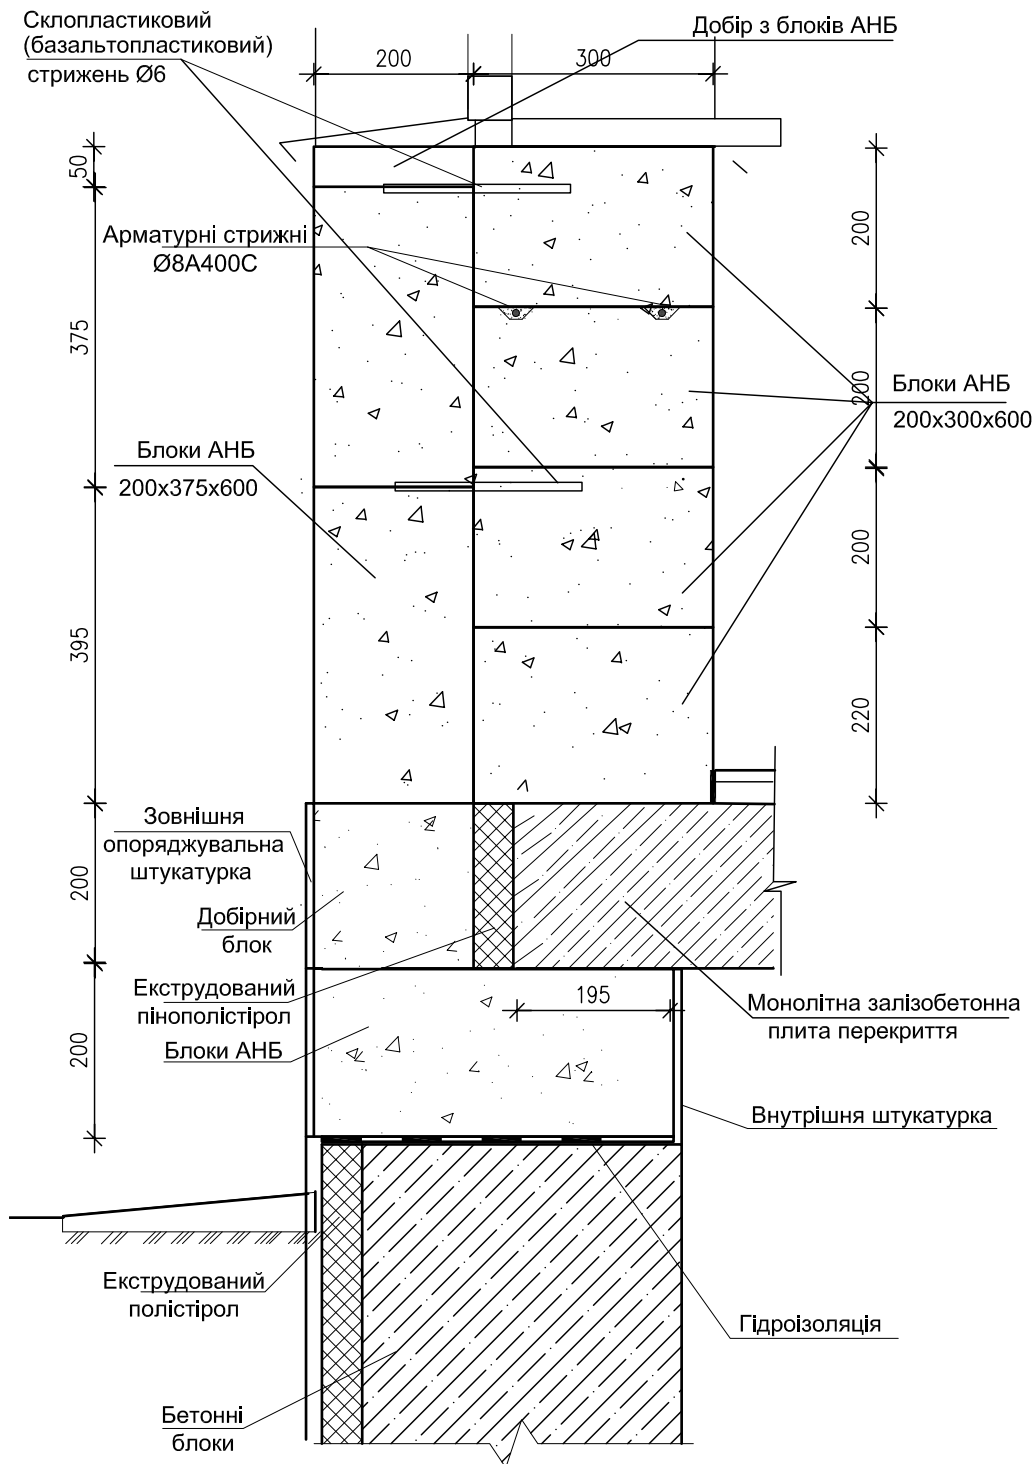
Двошарова стіна першого типу. Вузол спираєння стіни на блок фундаменту.
